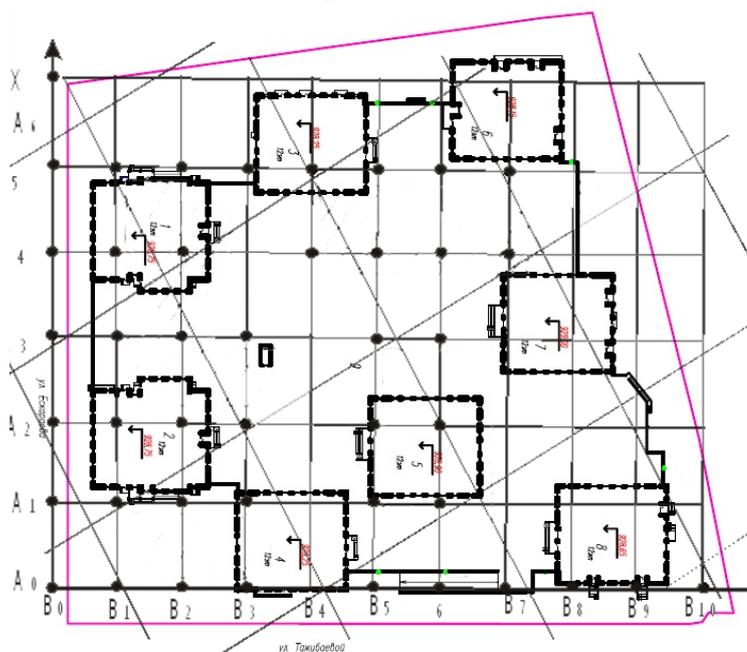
Строительная сетка жилого комплекса “Element”
